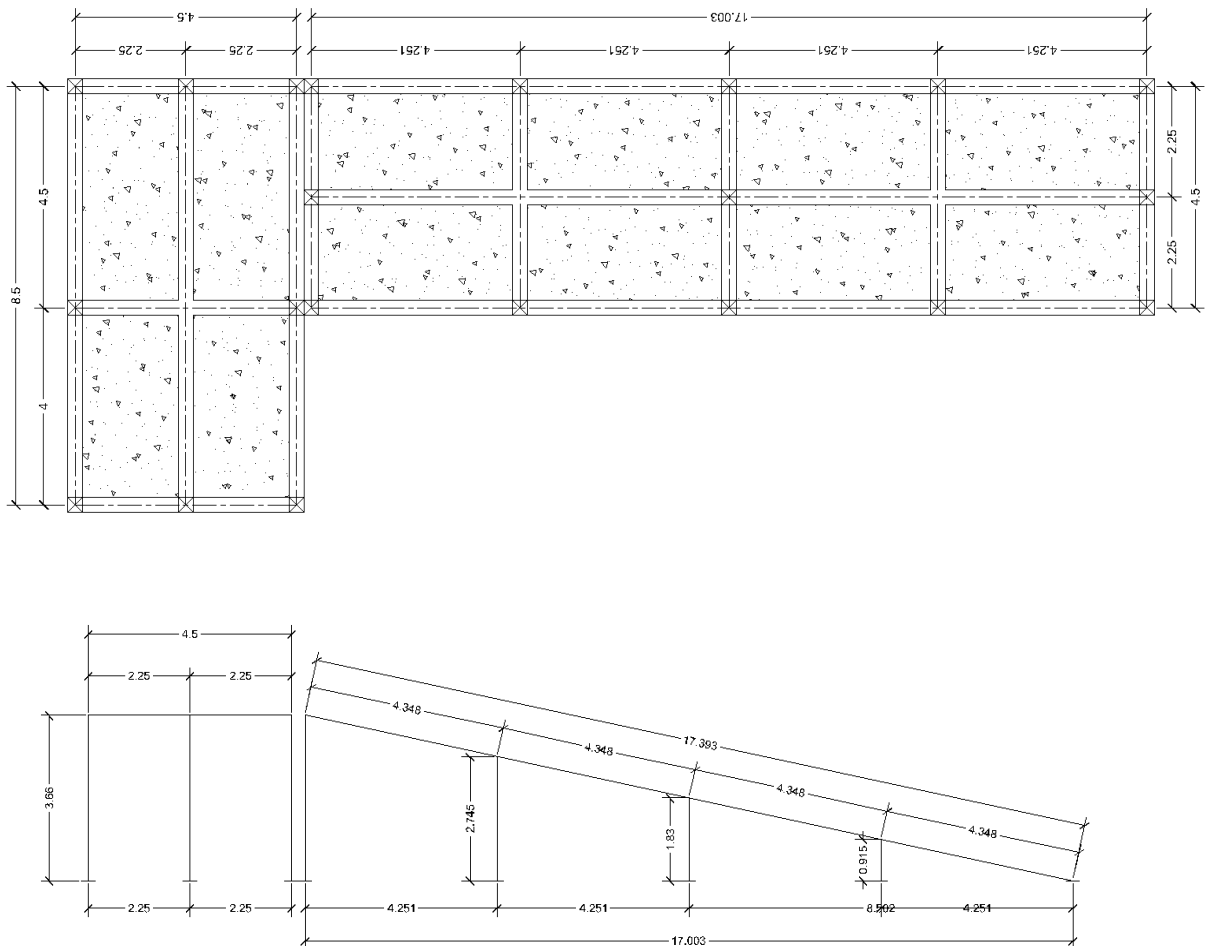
Vista de planta y de perfil de la Rampa
